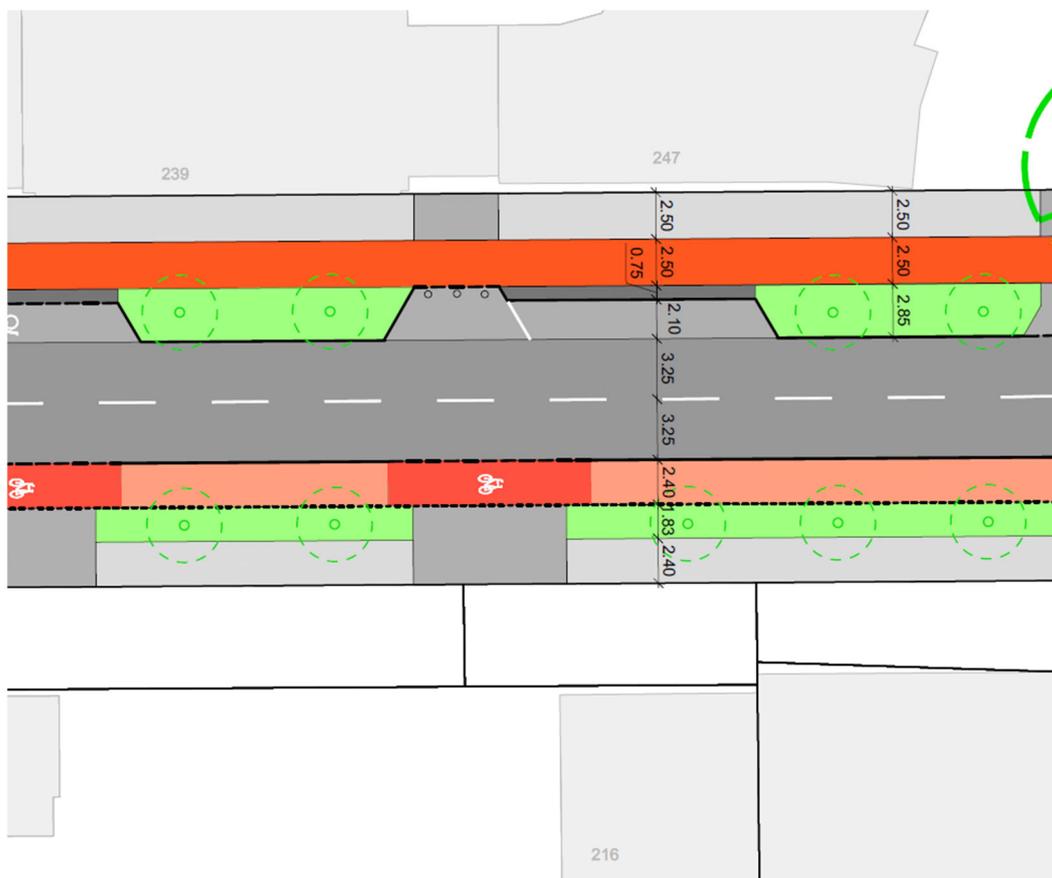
vereinfachter Lageplan Variante Kreisverkehr- Abschnitt Strecke, LSBG
